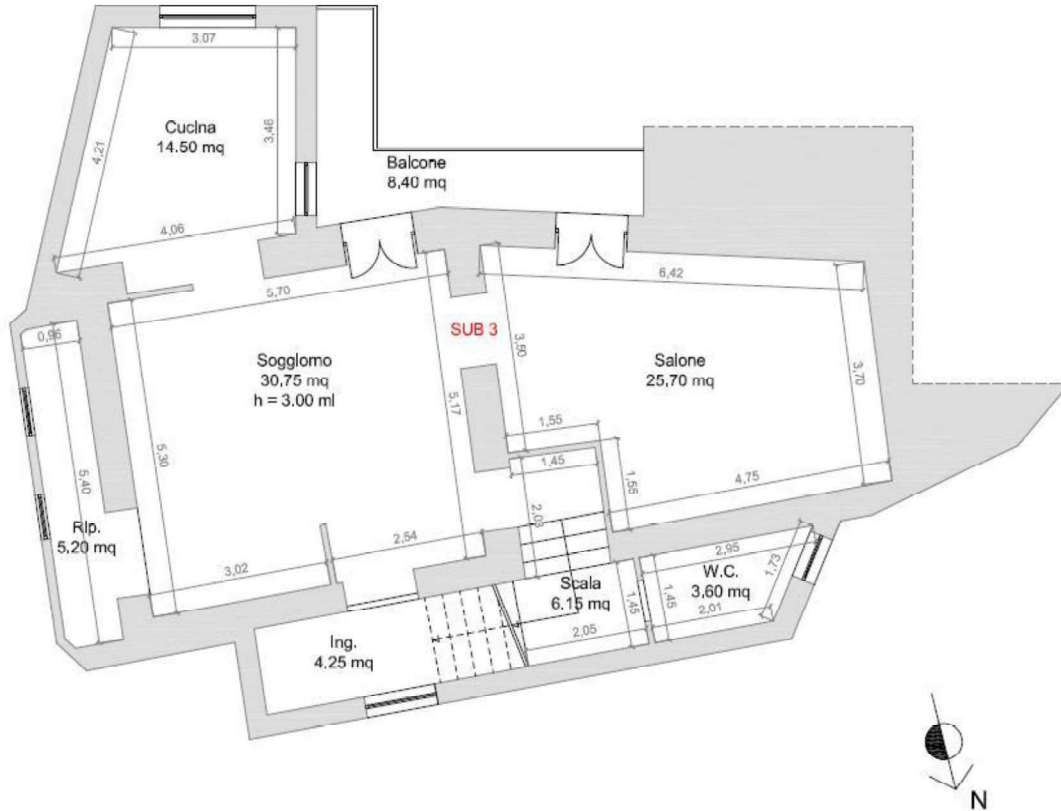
Planimetria Stato di Fatto Immobile, Piano 1, Foglio 35, p.lla 817, Sub 3.
